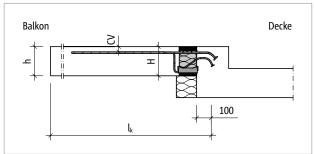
Schöck Isokorb® XT Typ K-O: Statisches System
